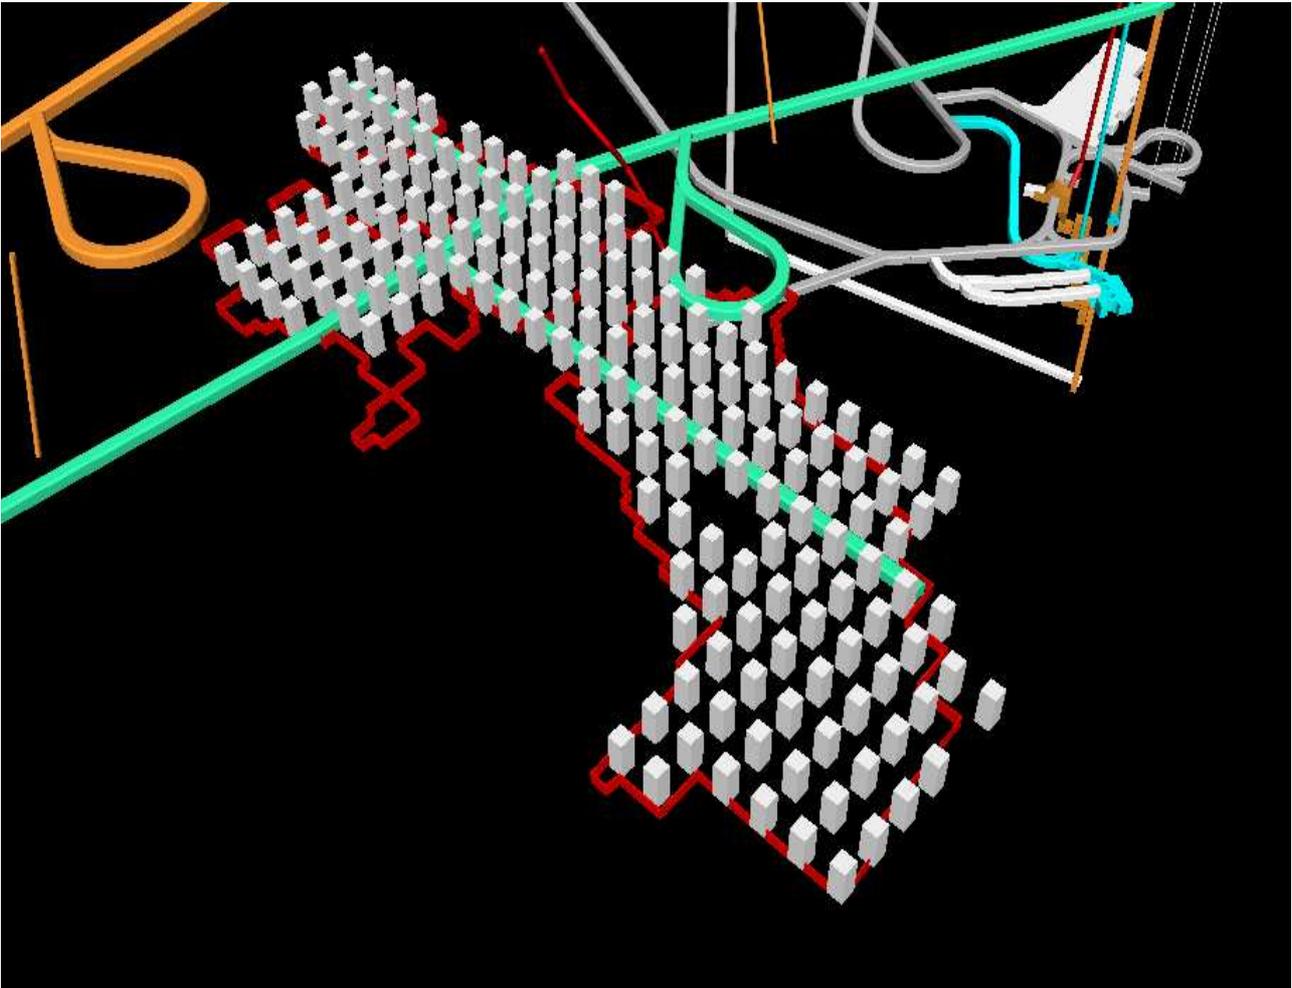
Sistema de minado, salones y pilares con corte y relleno.
